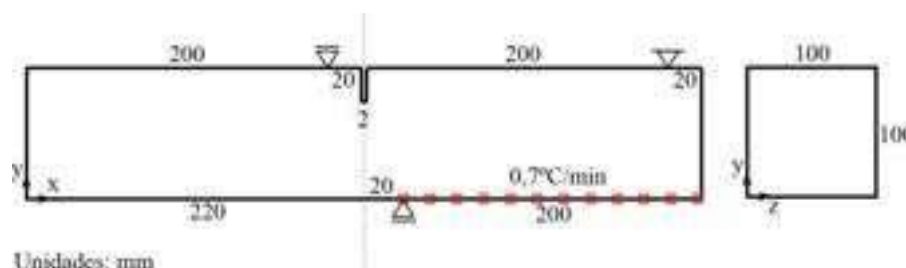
Viga submetida ao modo misto de fissuração.
